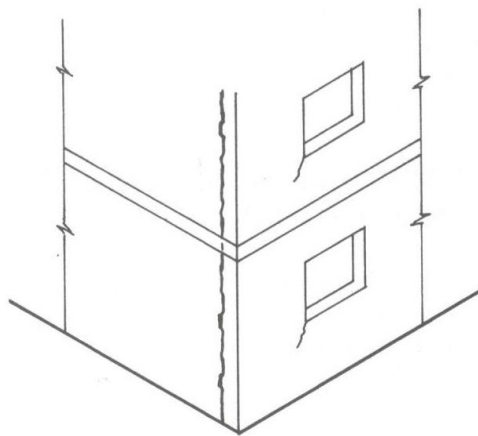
A expansão dos tijolos por absorção de umidade provoca o fissuramento vertical da alvenaria no canto do edifício.
